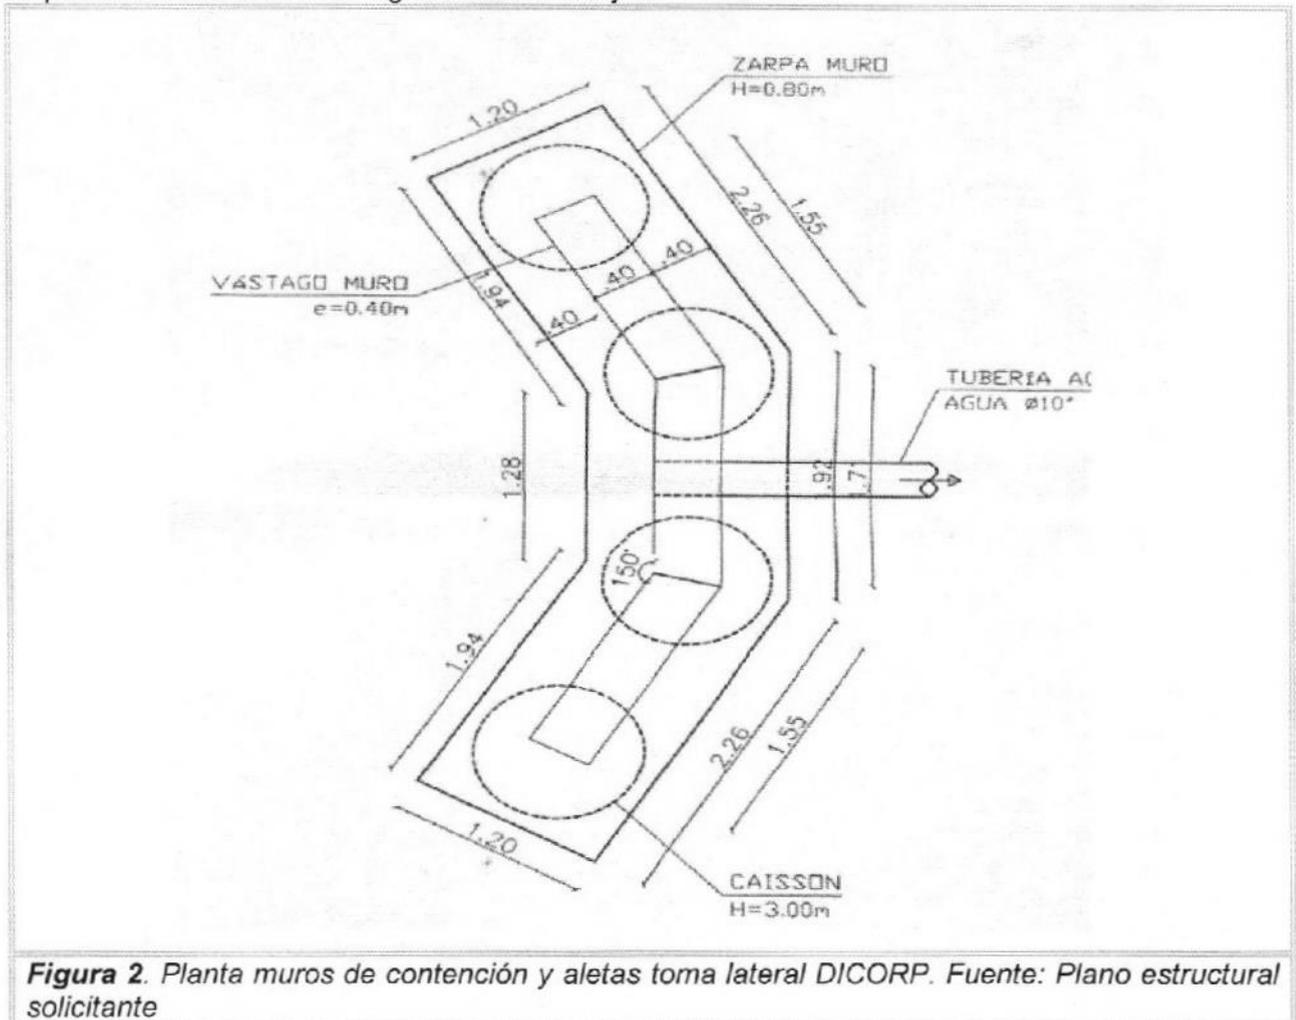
Planta muros de contención y aletas toma lateral DICORP. Fuente: Plano estructural solicitante
